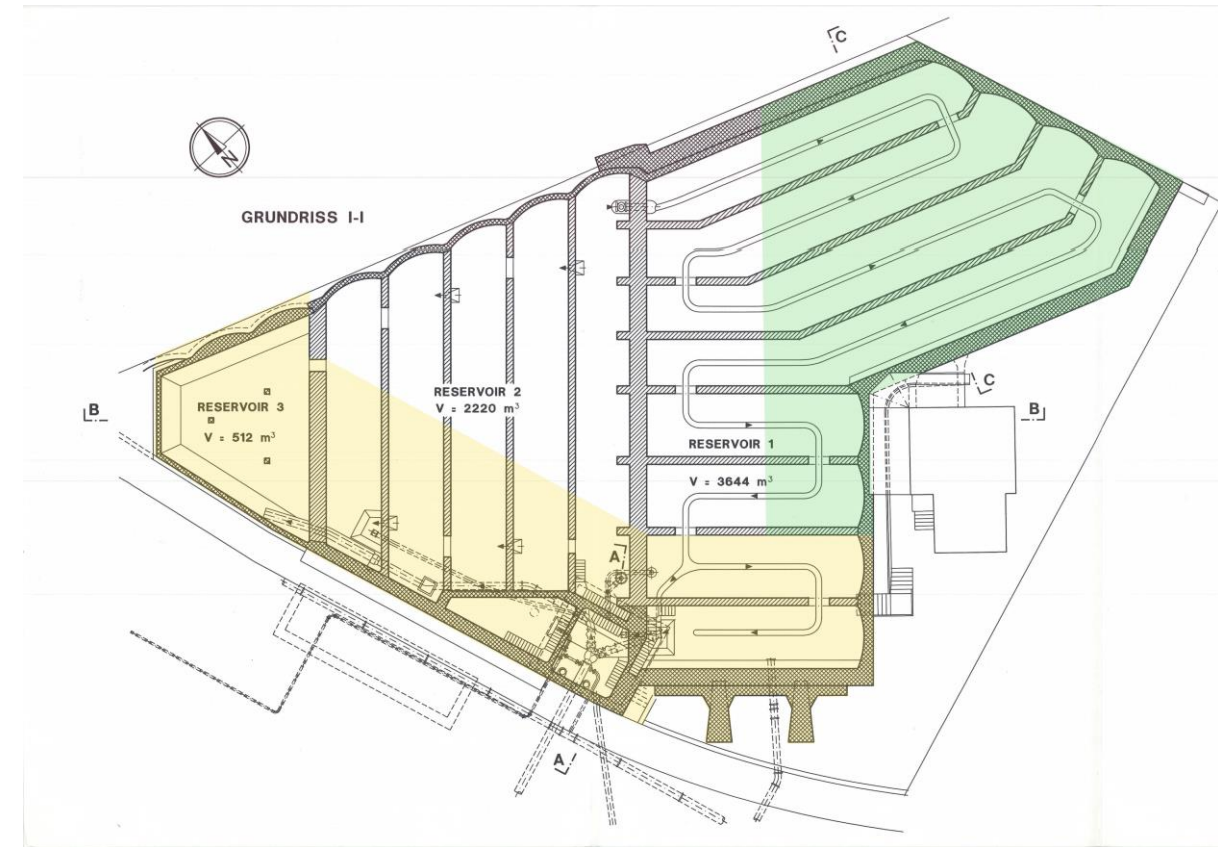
Grundriss des bestehenden Wasserreservoirs
